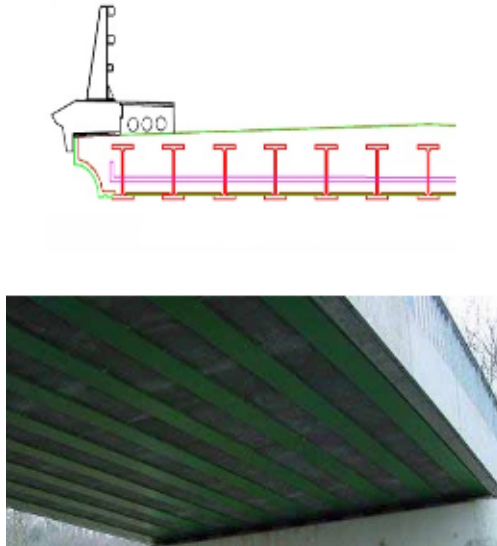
Pont mixte de type poutrelles enrobées.
